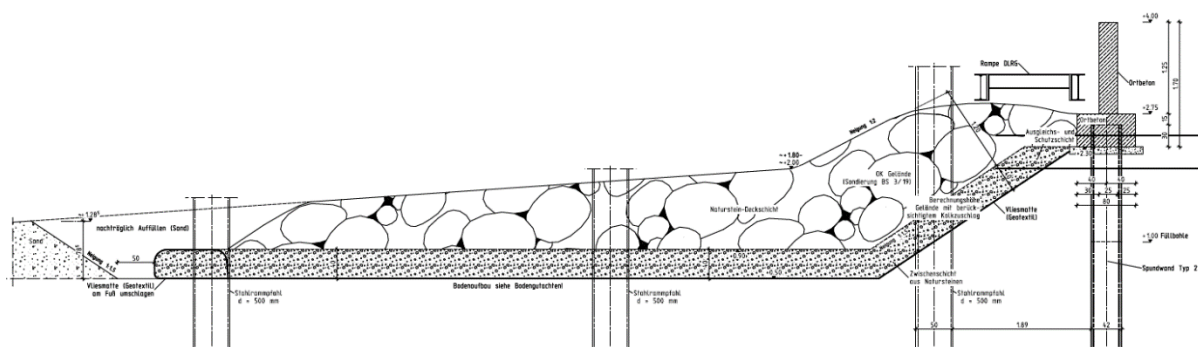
Schnitt HWS: Kolksicherung mit Deckwerk im Bereich Strandabgang
